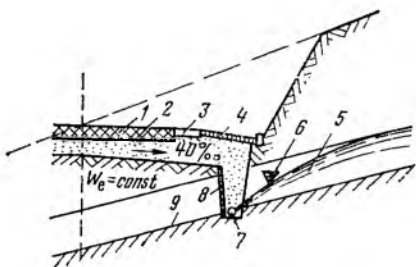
Конструкция глубокого дренажа для перехватывания уровня грунтовых вод и осушения дренарующего слоя дорожных одежд:
